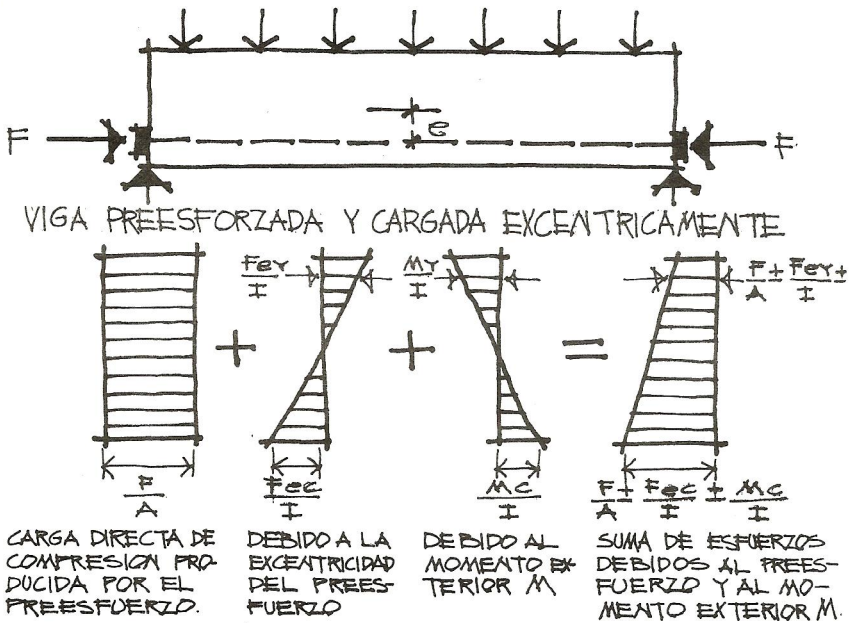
Distribución de esfuerzos en la sección preesforzada excéntricamente.
